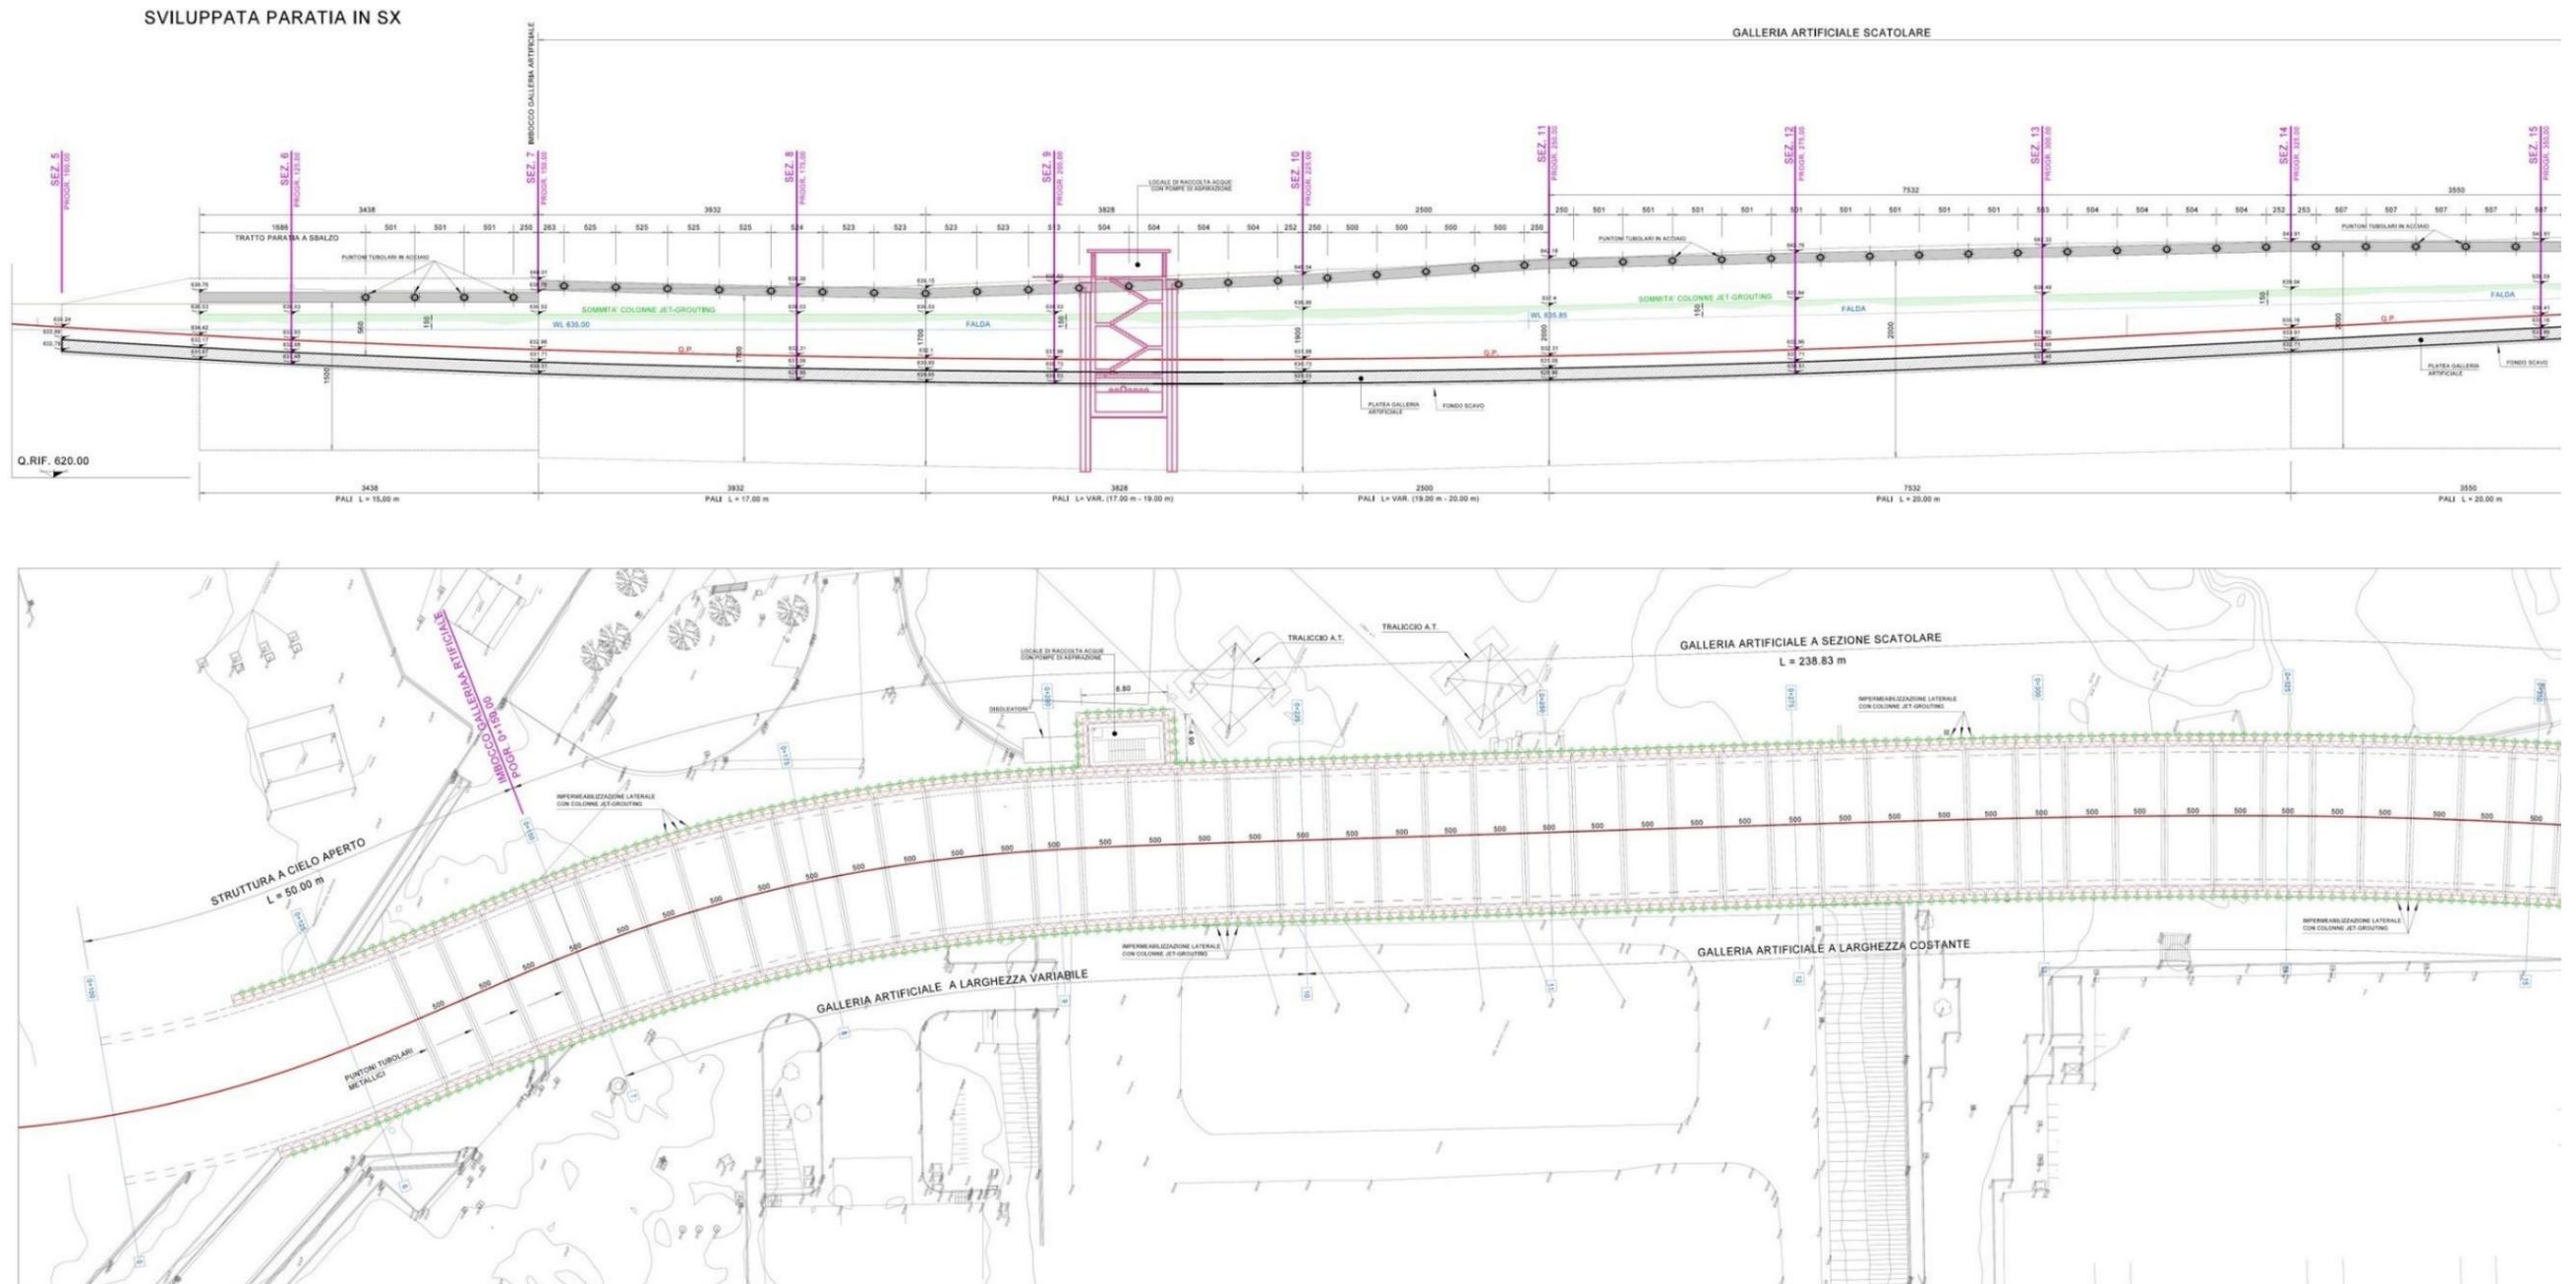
Galleria Artificiale Sud e tratto a cielo aperto – Planimetria e Sezione longitudinale – (1 di 2)
